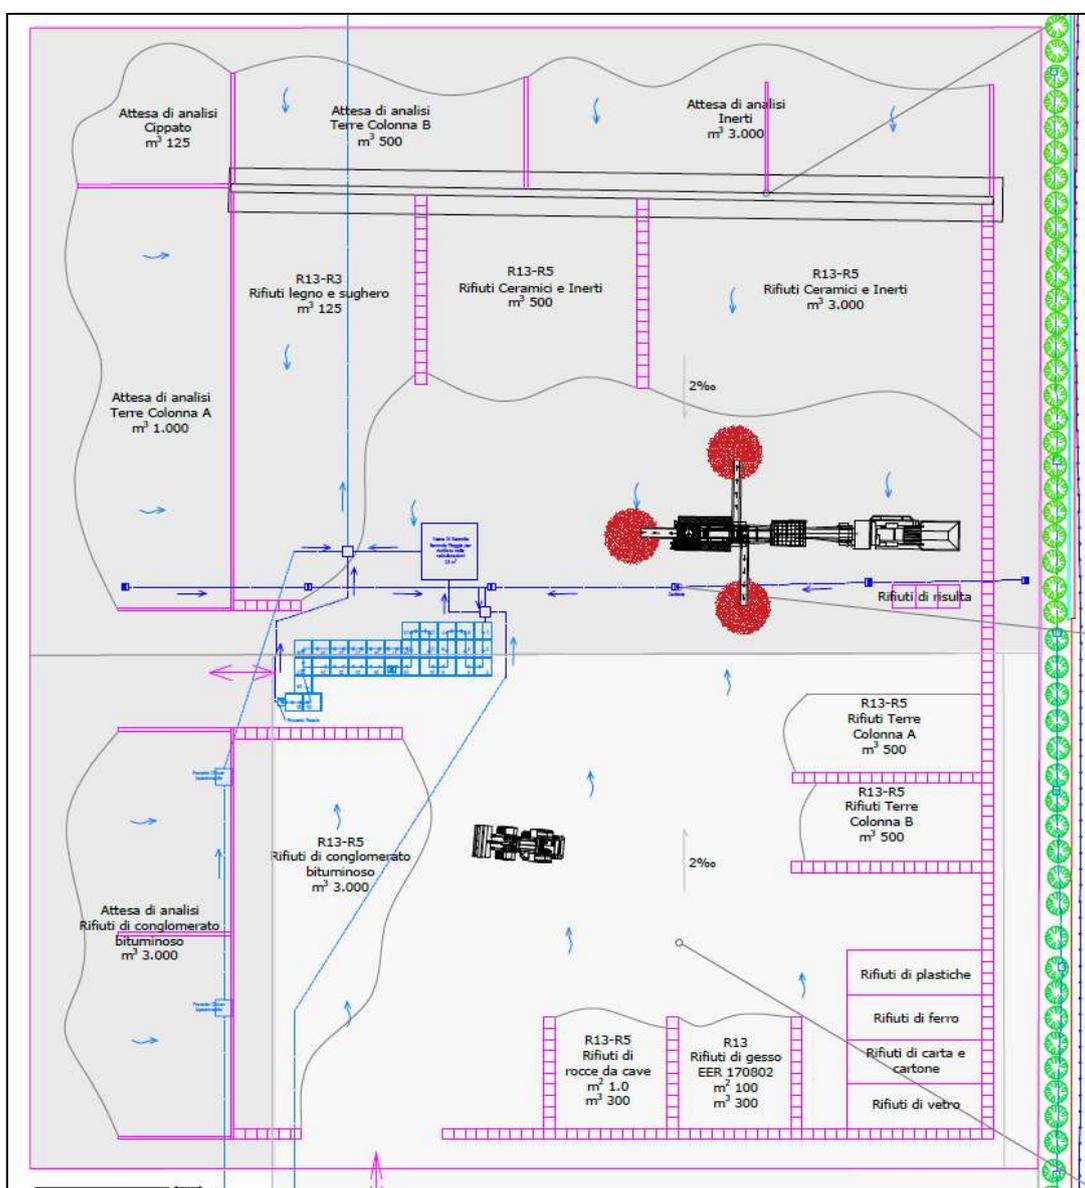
Planimetria dell'impianto con indicazione delle principali aree di lavoro
